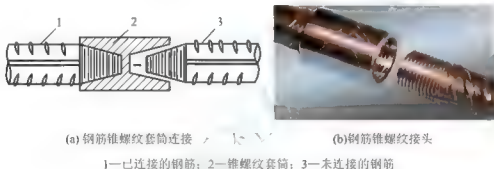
钢筋锥螺纹套筒连接和钢筋锥螺纹接头
